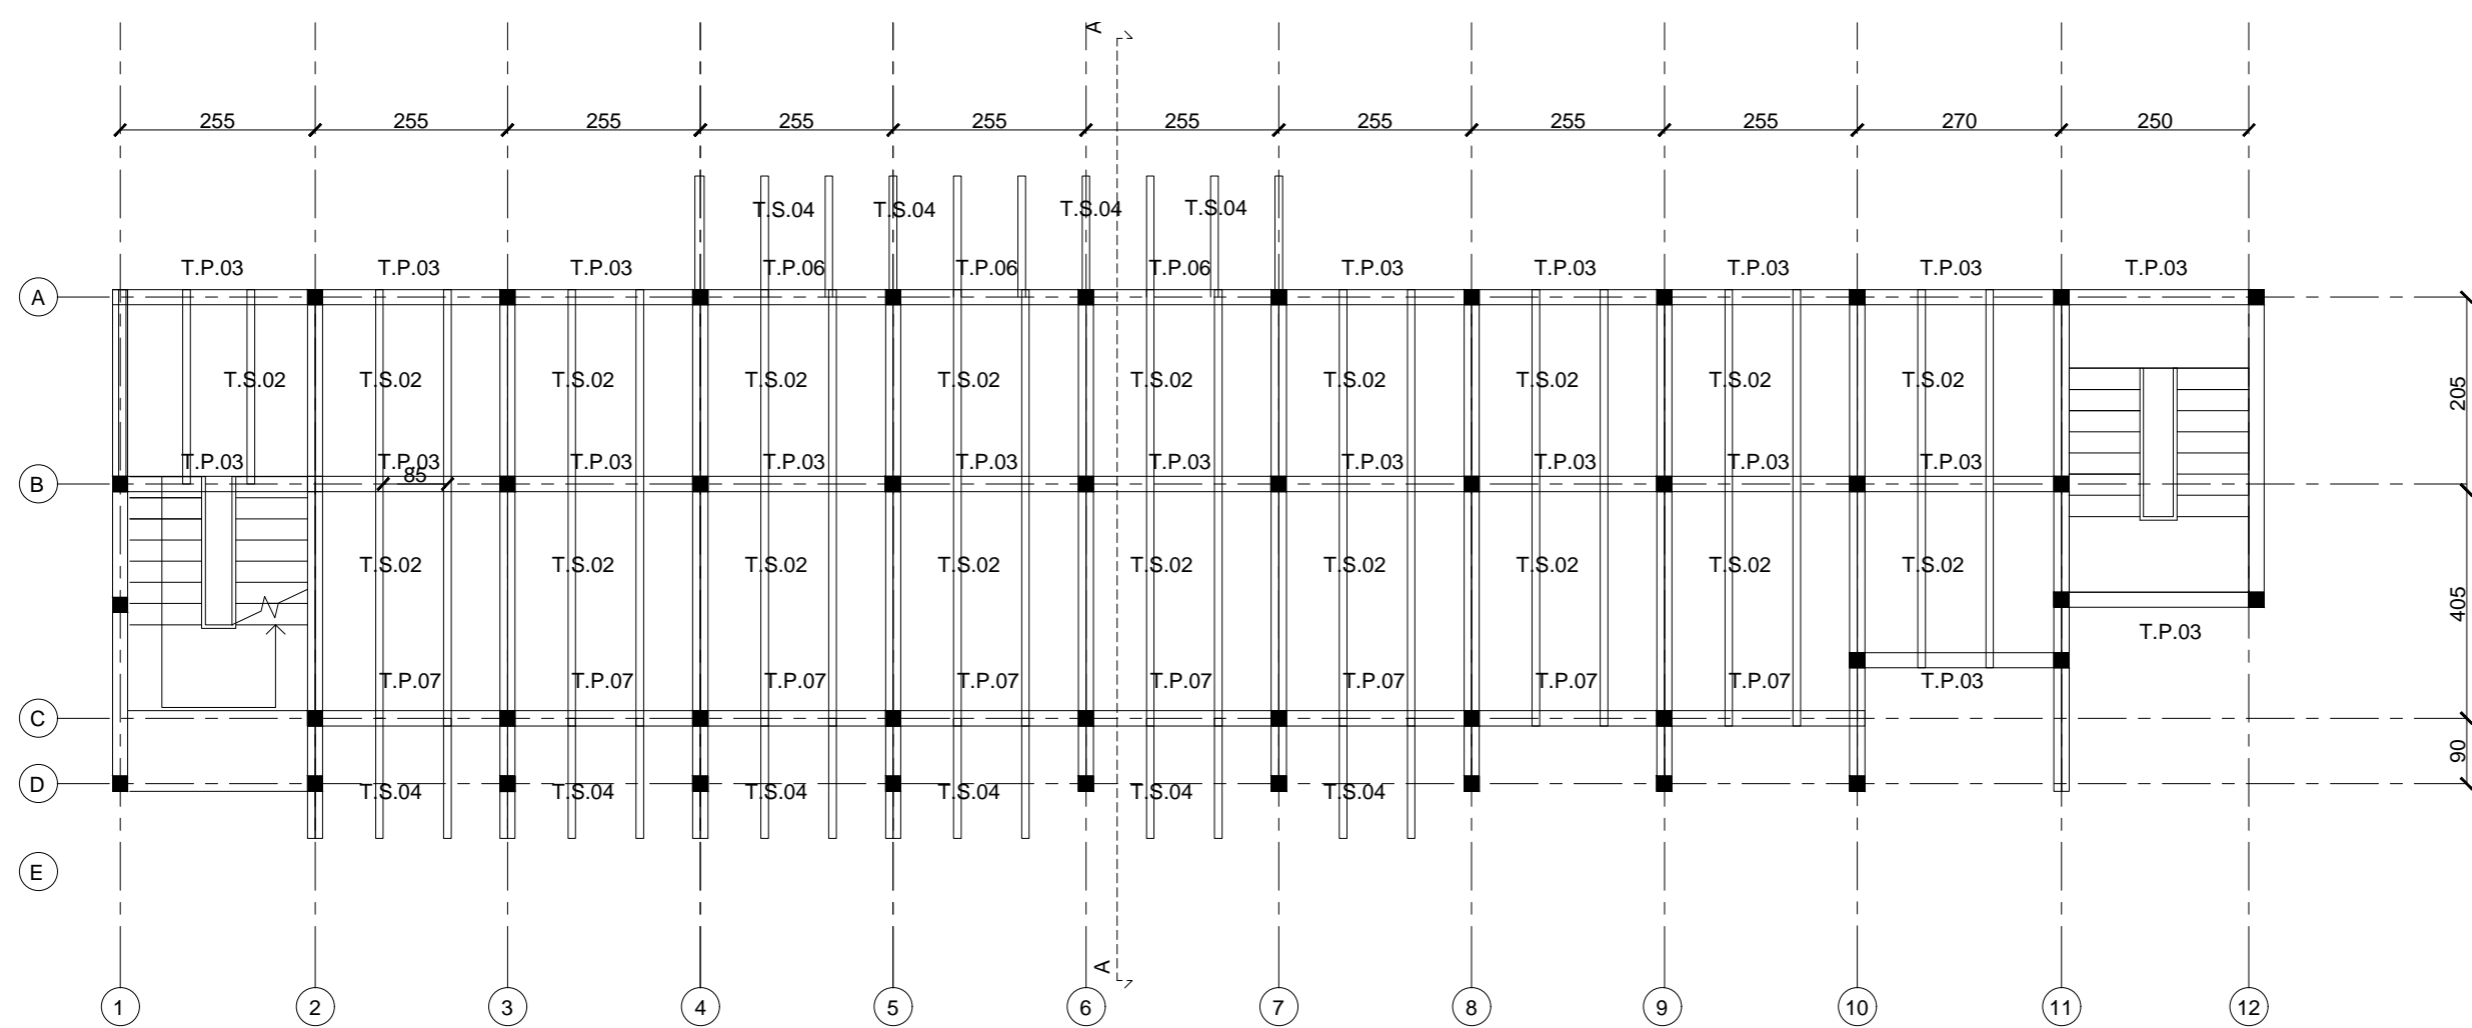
Pianta solaio piano primo scala 1:100.
